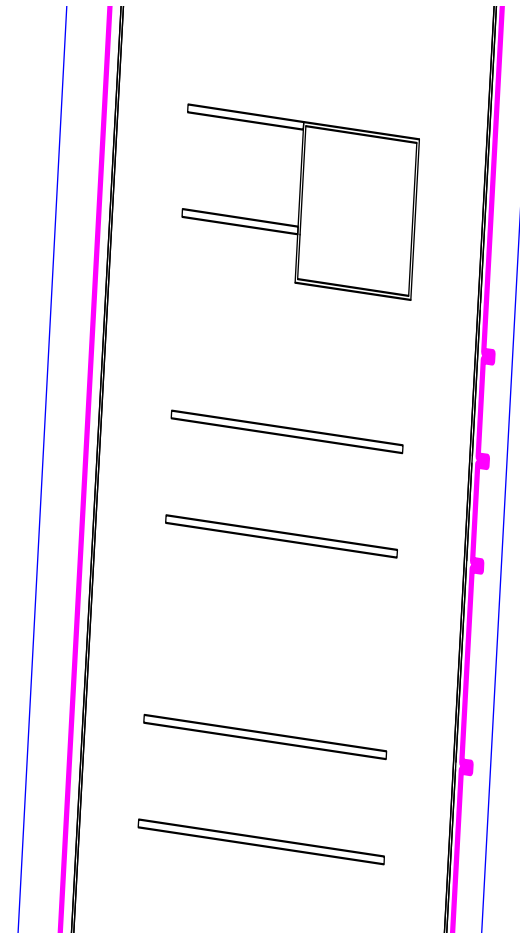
Plantilla de Pilas de cimentación, trabes, y cimentaciones corrida.
